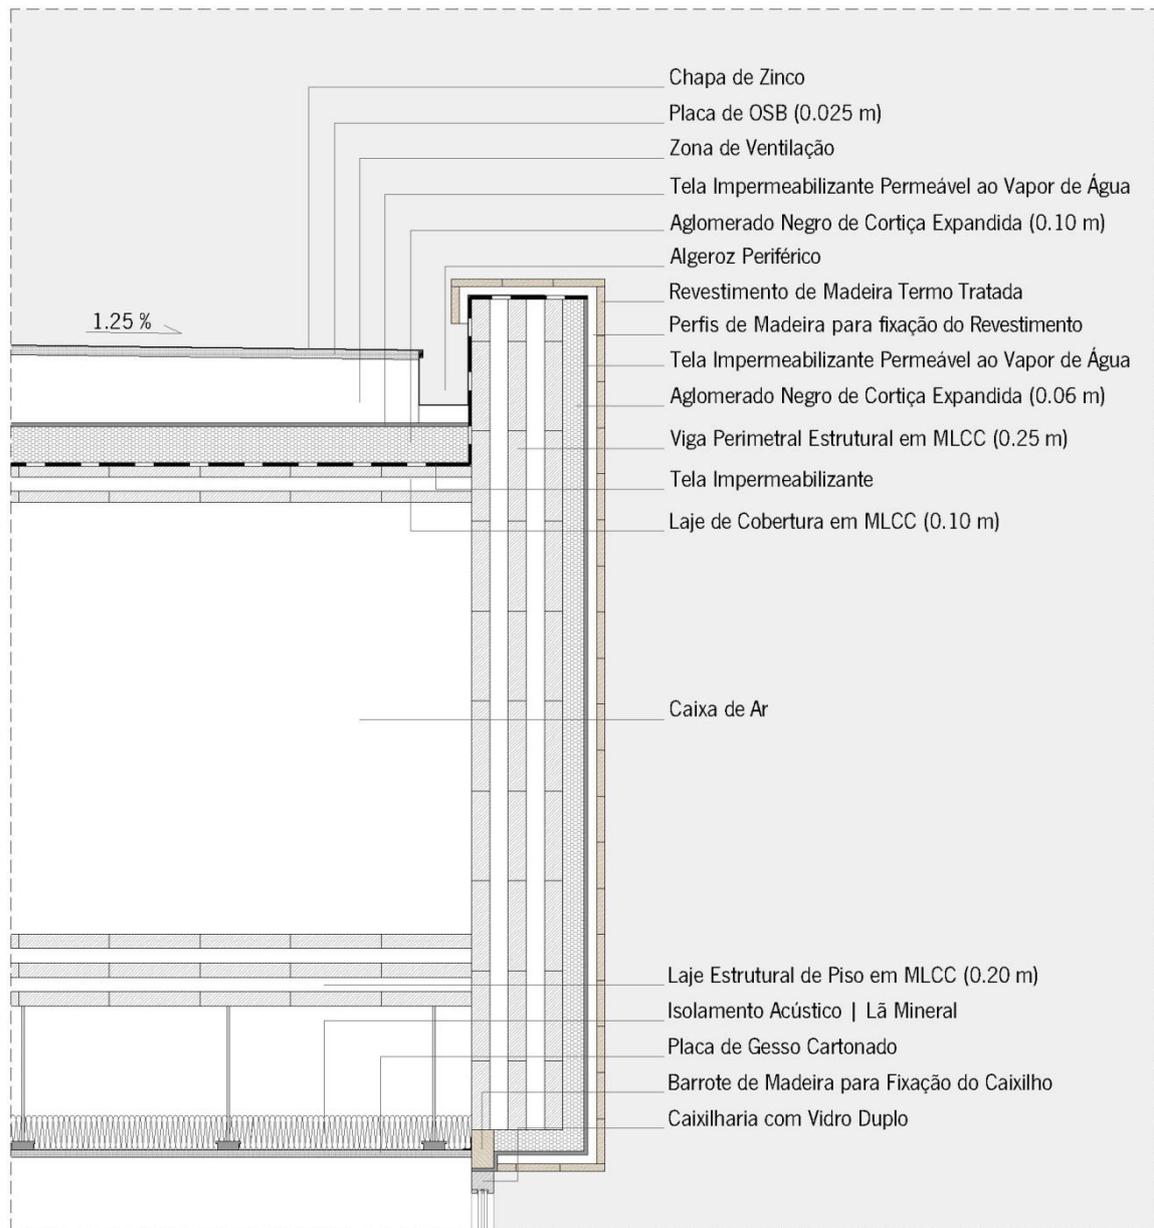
Pormenor Construtivo da Cobertura Adotada para o Edifício Proposto (Esc. 1/20)
